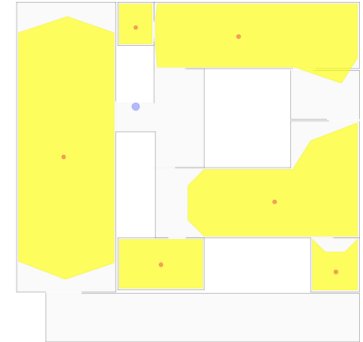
Grundriss vom 1. Obergeschoss
